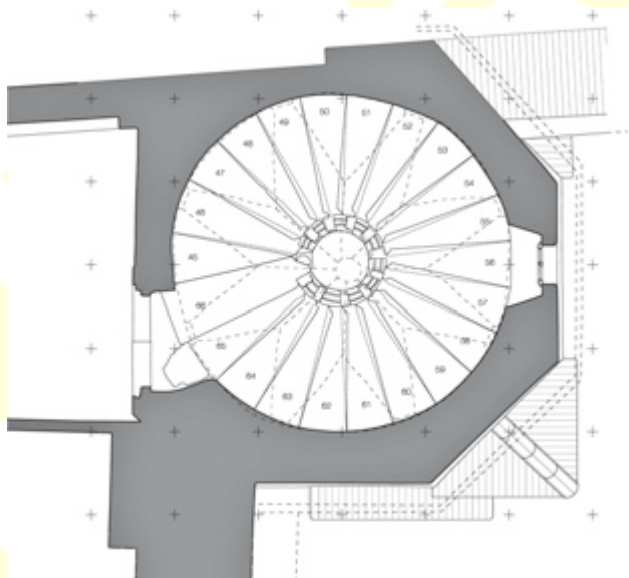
Orth an der Donau, Schloss. Wendeltreppe. Grundriss des 3. Obergeschoßes und Ansicht des Sterngratgewölbes, um 1550.
